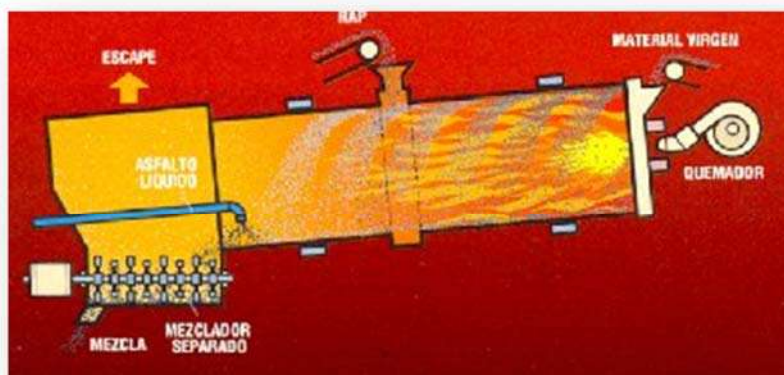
Planta continua con secador de flujo paralelo con mezclador separado (DMC I).
